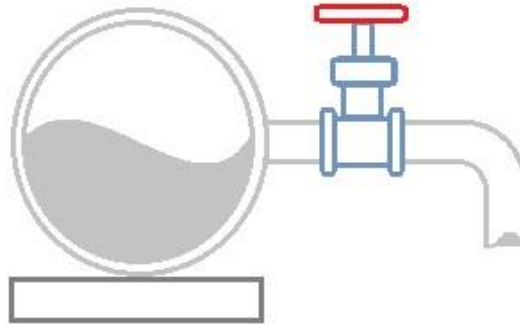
Esquema de colocación de la válvula de purga (vista de alzado)
